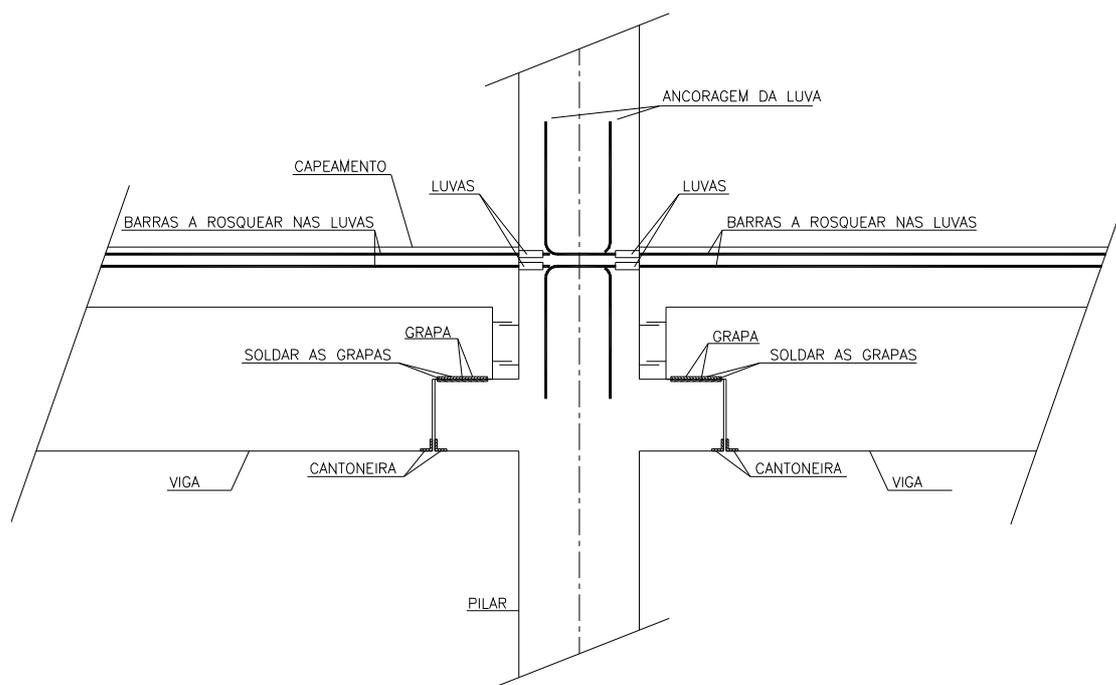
Esquema de ligação entre pilar e viga com luvas e barras roscadas.
